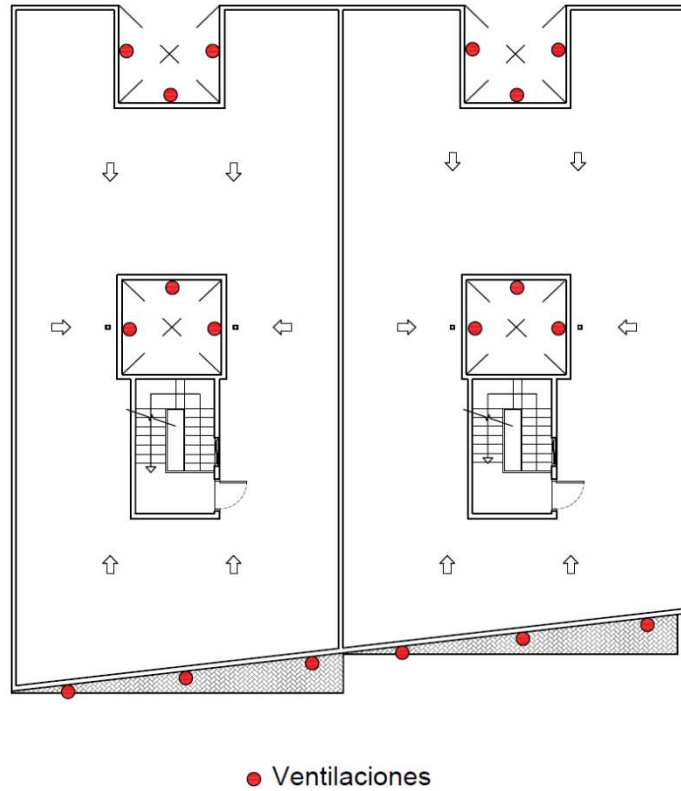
Planta cubierta - Situación de las ventilaciones, (Fuente: autor).
